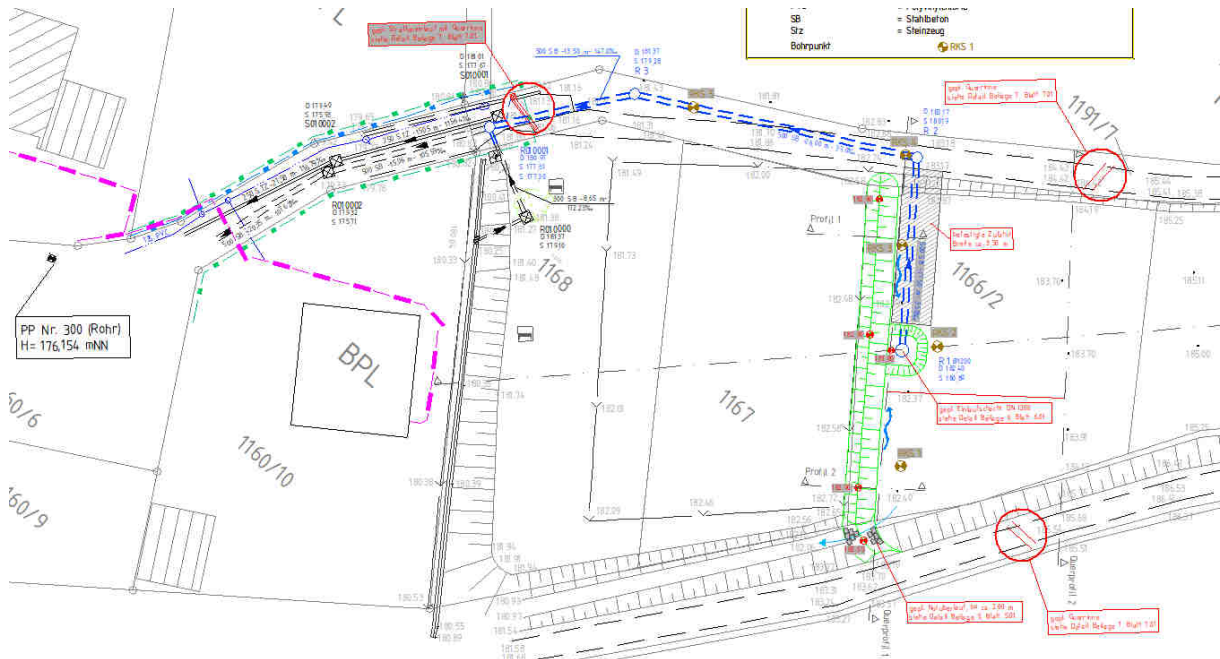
Lageplanausschnitt Ausschreibung Maßnahme "Am Schloßberg"
